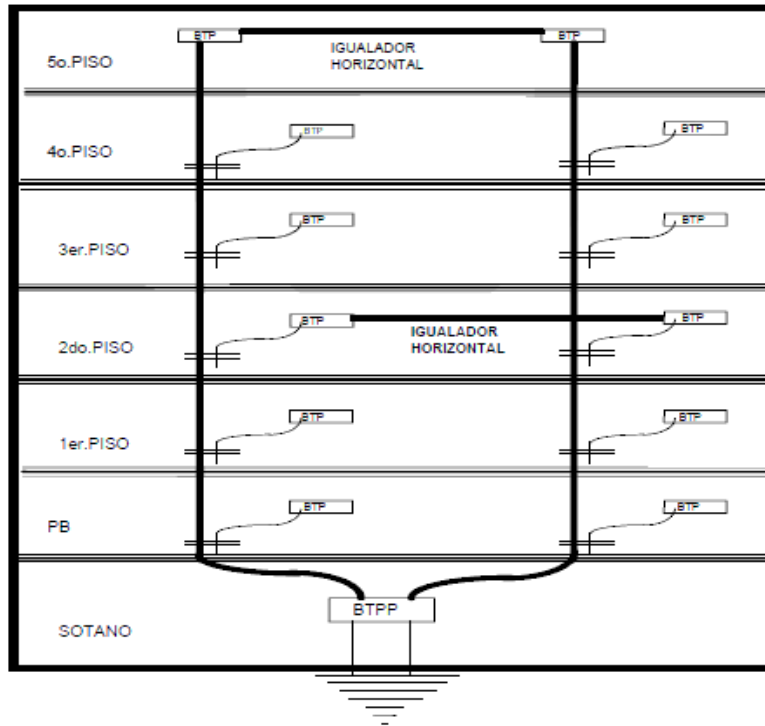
Instalación típica de cables verticales e igualadores horizontales.
